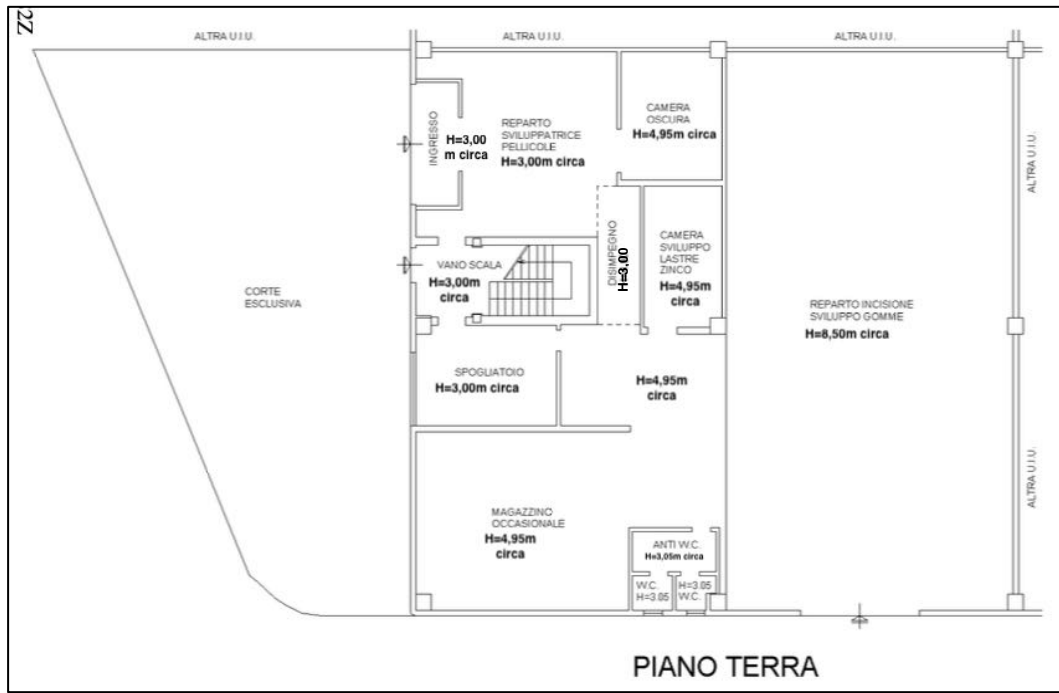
Planimetria catastale F.5 P.1067 S.12 del 03/03/2017 con indicazione delle altezze
